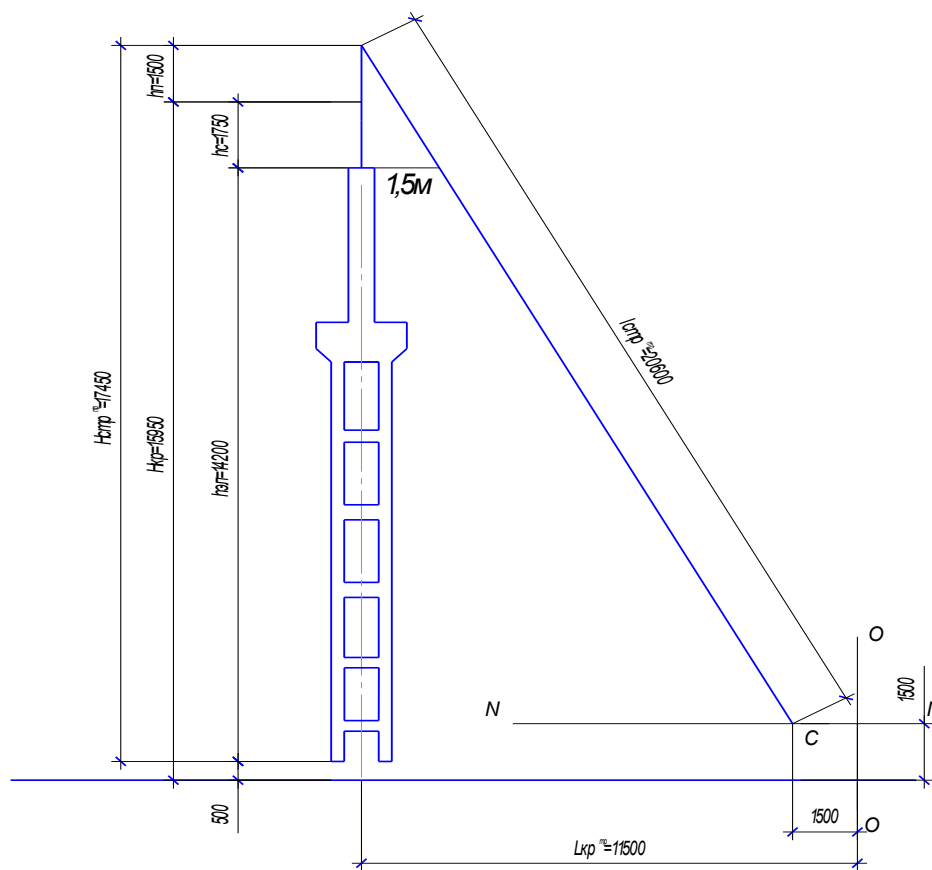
Схема для определения параметров крана при монтаже колонн
